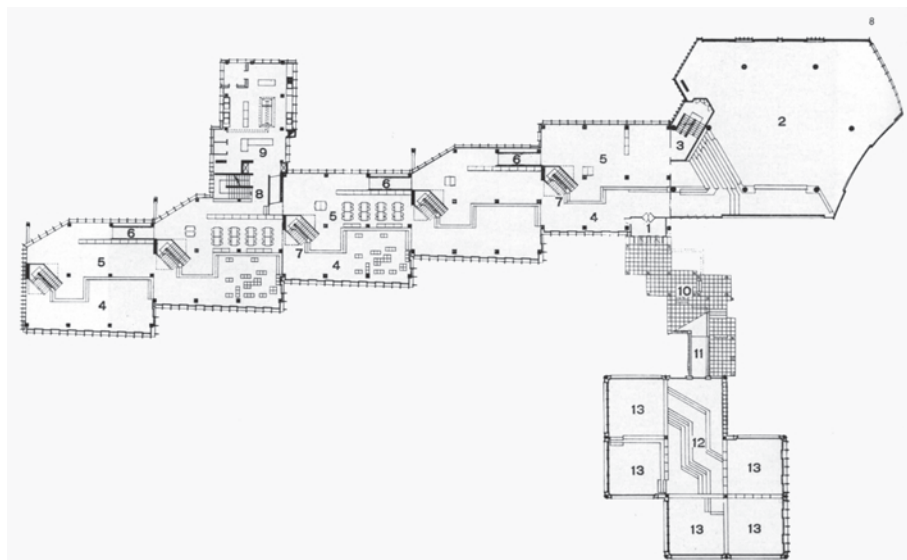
Olivetti-Ferienkolonie: Grundriss EG
